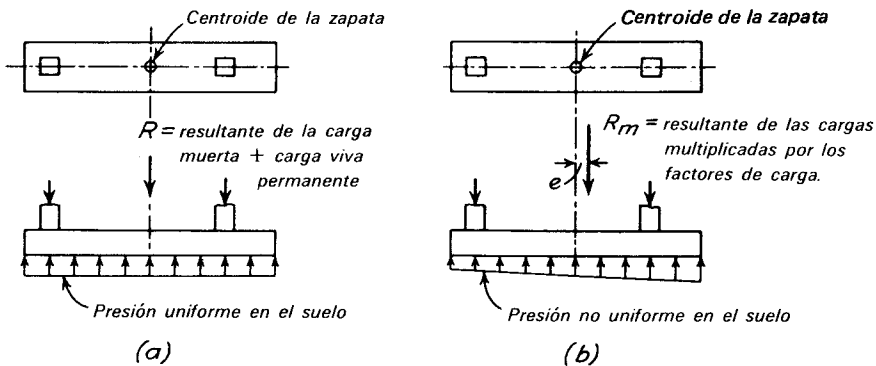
Fuerzas que hay que considerar a) para determinar las dimensiones de las zapatas rectangulares combinadas y b) para hacer el proyecto estructural de la zapata.
